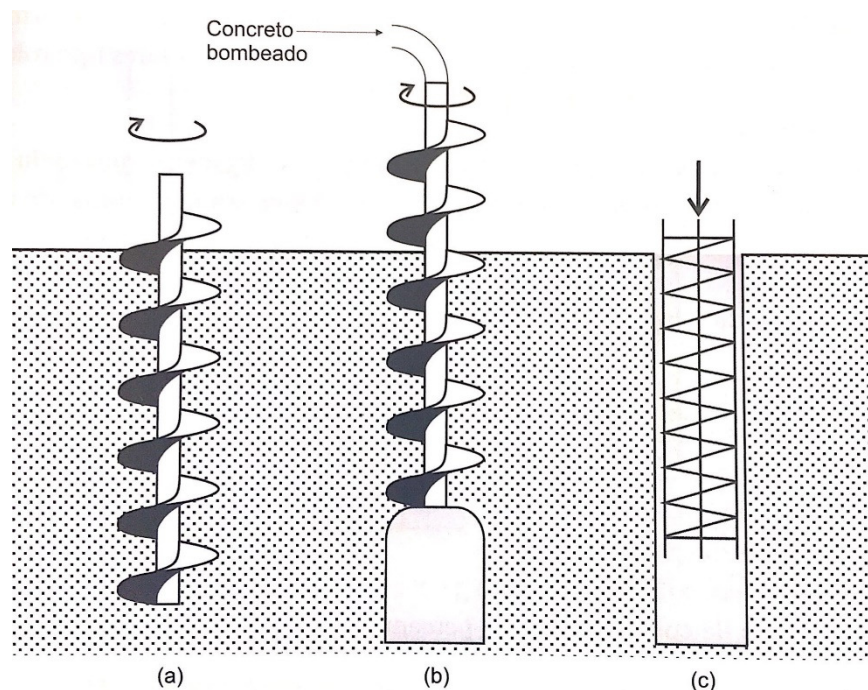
(a) escavação do fuste da estaca; (b) lançamento do concreto durante a retirada da hélice contínua; c) instalação da armadura. (Fonte: VELLOSO e LOPES, 2010)
